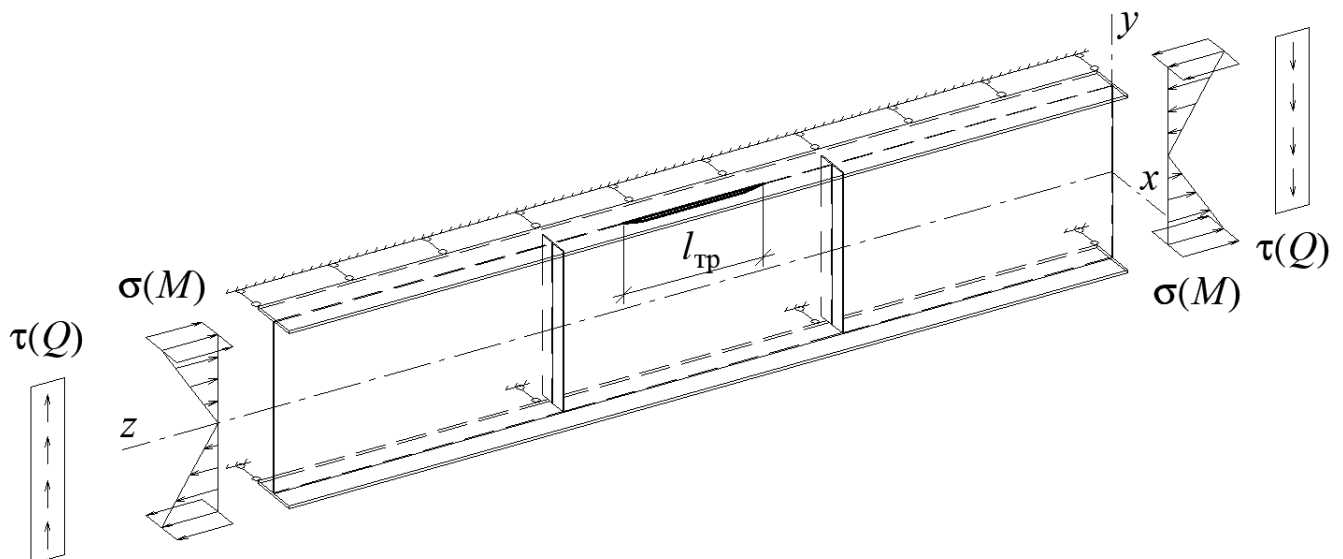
Общий вид расчетной модели подкрановой балки с граничными условиями и приложенной нагрузкой
